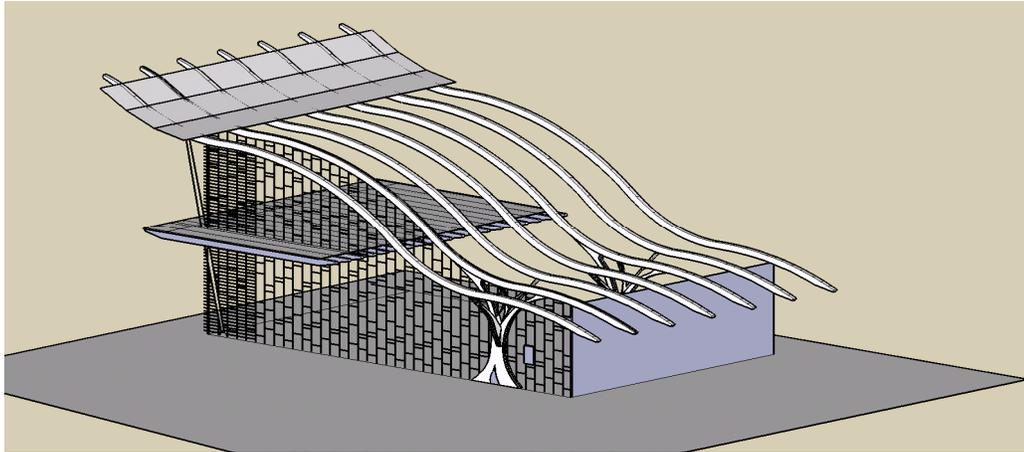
Primeira proposta de anteprojeto para a construção do CIT.
